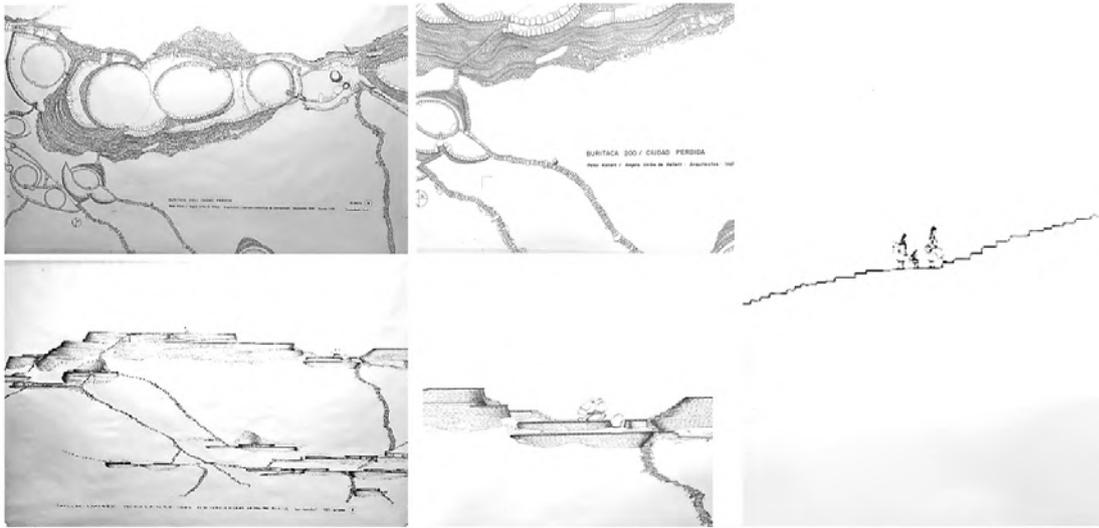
Planos originales 15 plano (1) y detalles de los planos, realizados por Kellett y Uribe (1984). Biblioteca del ICANH. Fotografías (2021) y composición, M.I. Mayorga, 2023.
